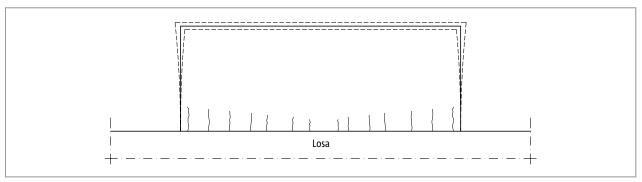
Losa de balcón sin Schöck Isokorb®: Posibilidad de agrietamiento debido a la fatiga
